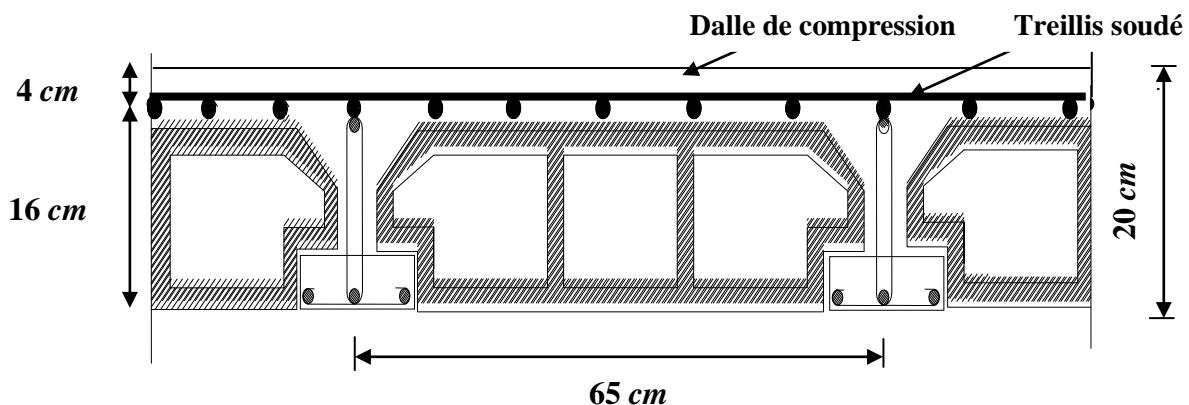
Schématisation d'un plancher (16+4) cm à corps creux.
